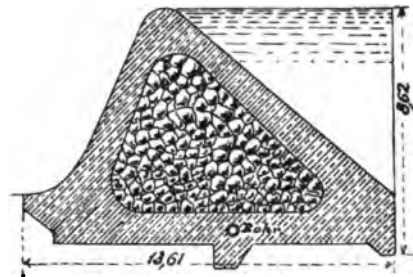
Hohles Wehr mit Steinfüllung nach John Fielding.
